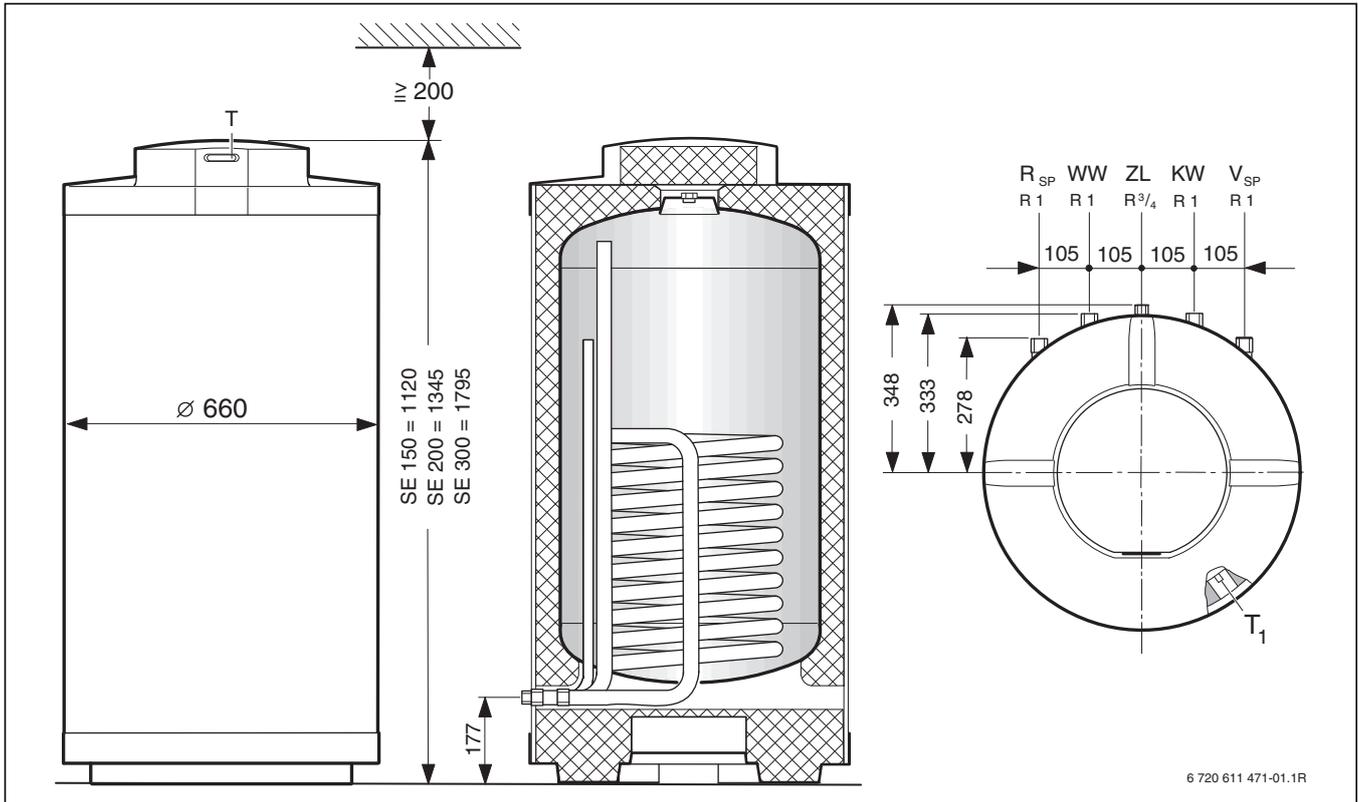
Bau- und Anschlussmaße SE 150/200/300-1
